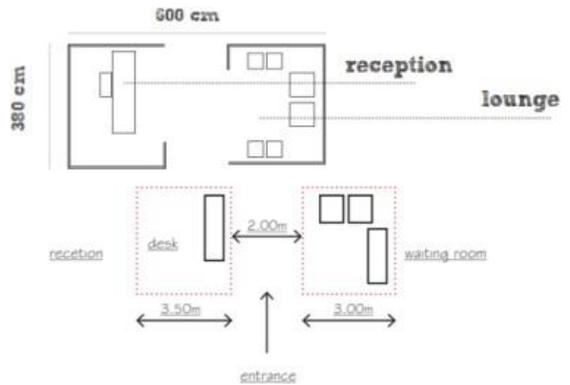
4 Layout Furnitur Ruang Kerja
